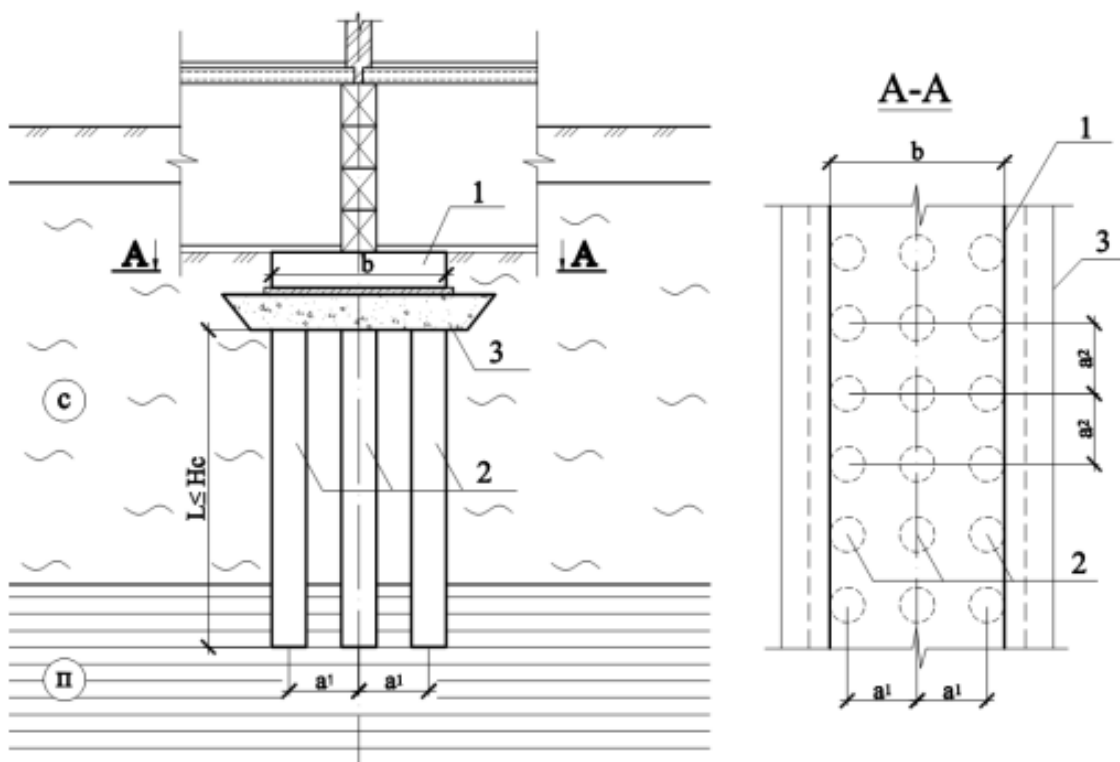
Підсилення слабкої основи стрічкового фундаменту вертикальними ґрунтоцементними елементами: с – слабка основа; п – придатна основа; 1 – стрічковий фундамент; 2 – вертикальні ґрунтоцементні елементи; 3 – щебенева розподільча подушка
